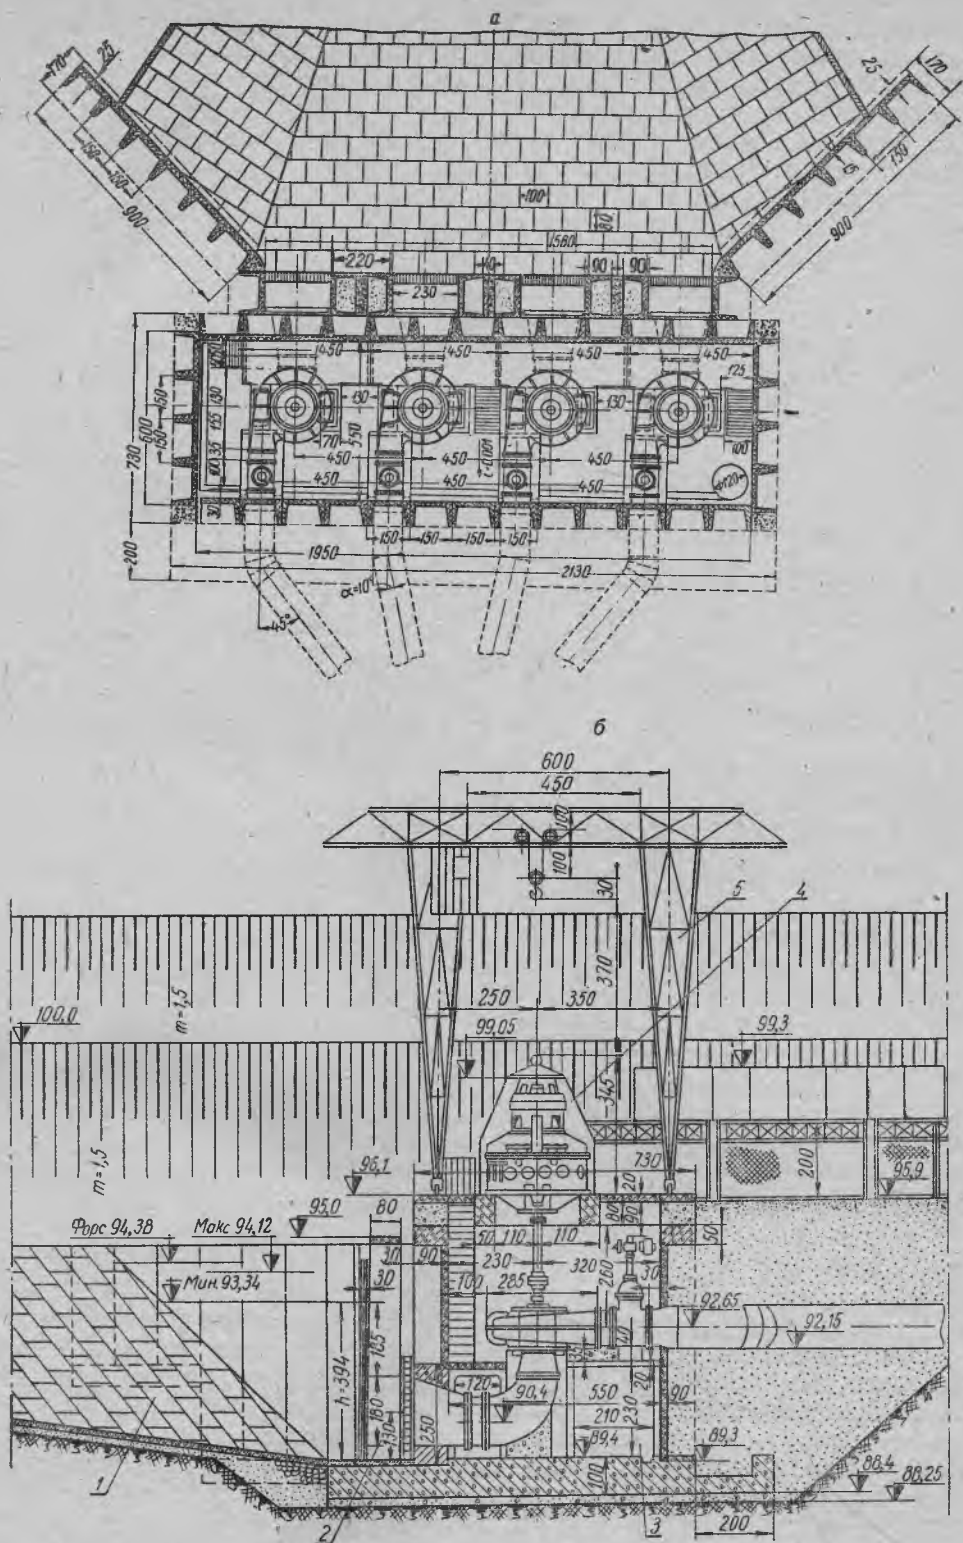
Поперечный разрез открытой оросительной насосной станции камерного типа с сухой камерой из сборных железобетонных элементов:
